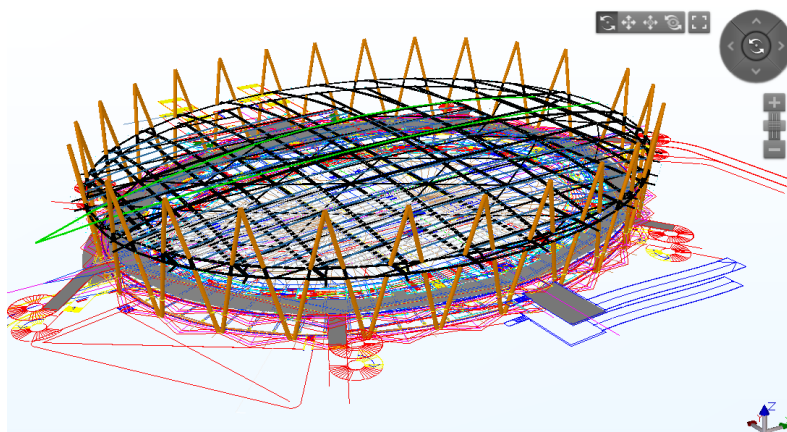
Vista de modelo BIM para el desarrollo de la ingeniería de detalle
